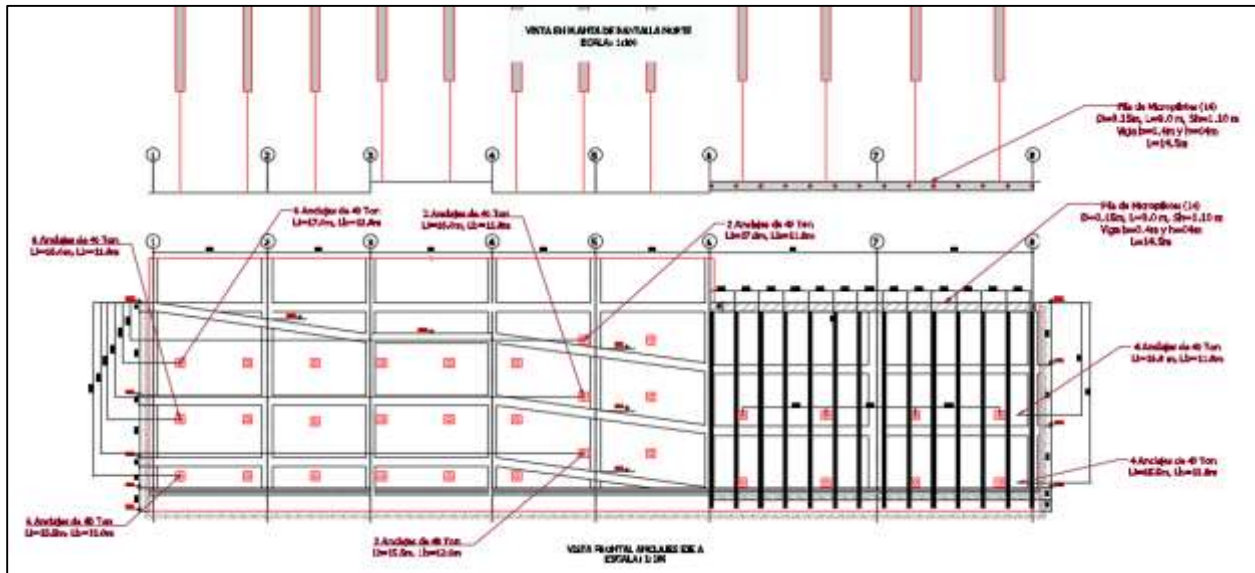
Vista en alzada y planta de Pantalla Norte - Proyecto San Agustín
